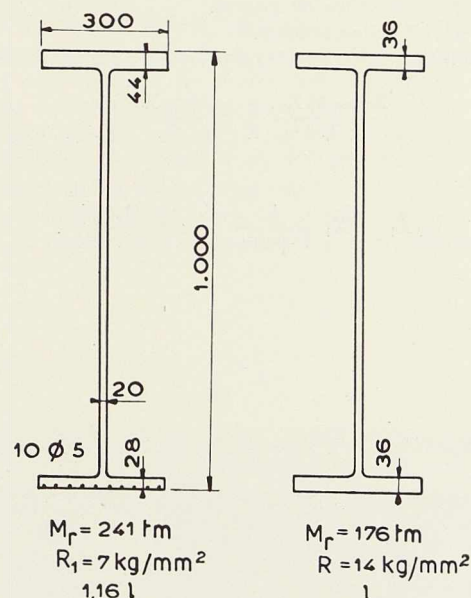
Gain de poids d'une poutrelle à semelles non symétriques, la semelle étirée étant précomprimée, par rapport à une poutrelle standard.
